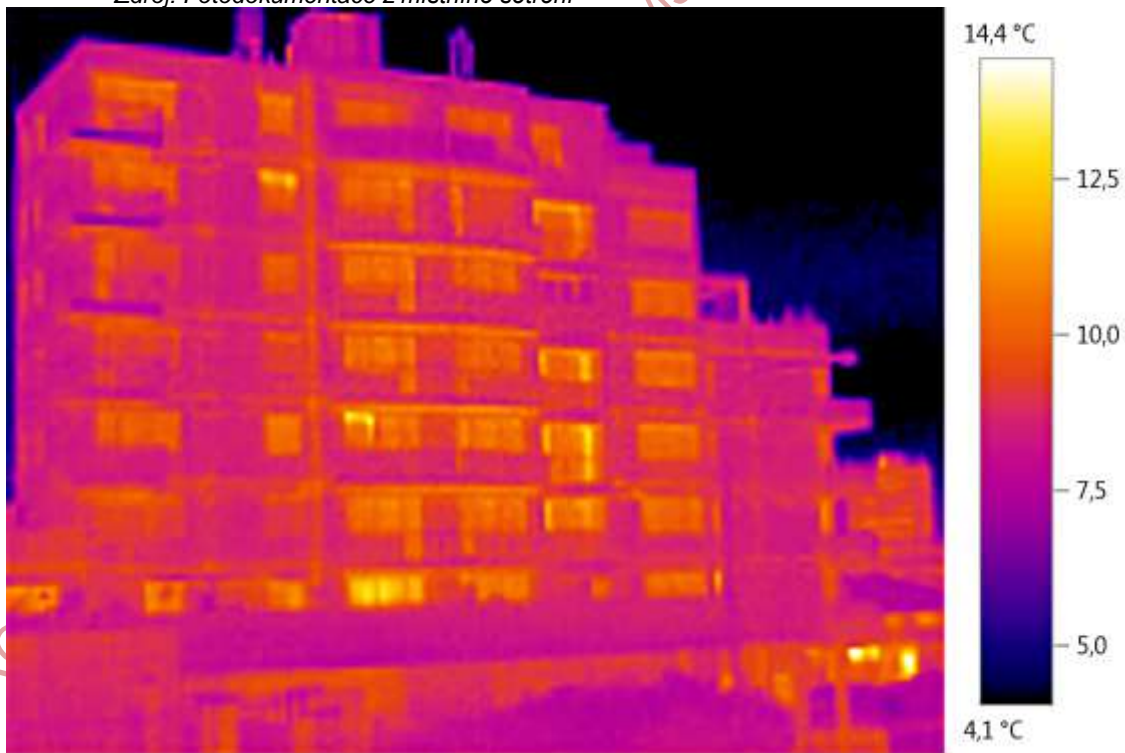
Západní fasáda. Termovizní snímek dokumentující zvýšenou povrchovou teplotu fasády v místech železobetonových stropních ztužidel, sloupů skeletu, ale i vykrakorcovaných balkónů
